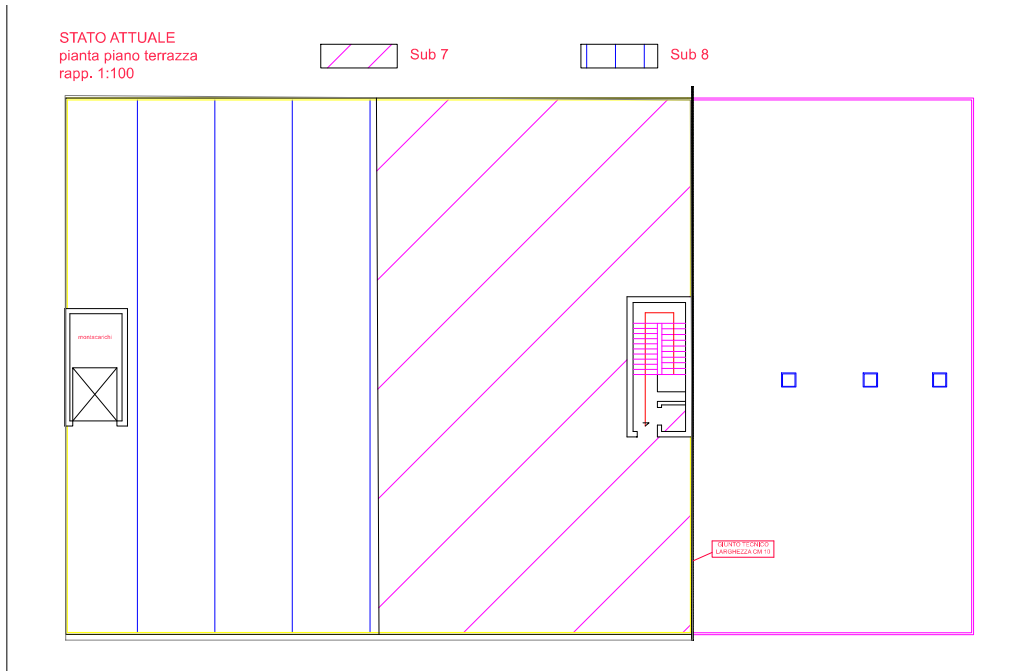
Planimetria rilevata terrazzo con individuazione sub 7 e sub 8
